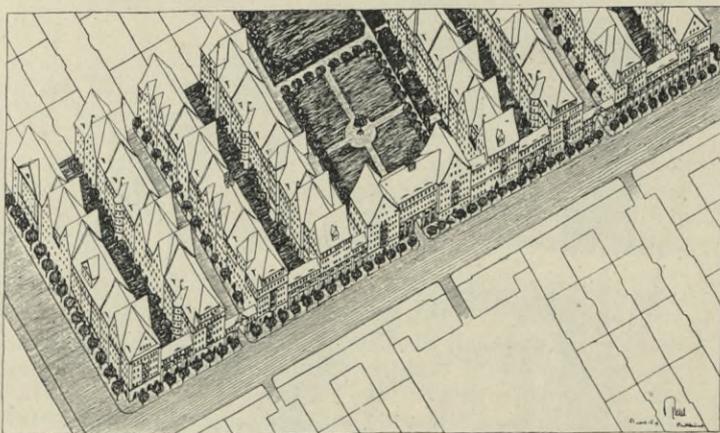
Aufriß zu Abb. 297. Architekt Stadtbaurat Kiehl
